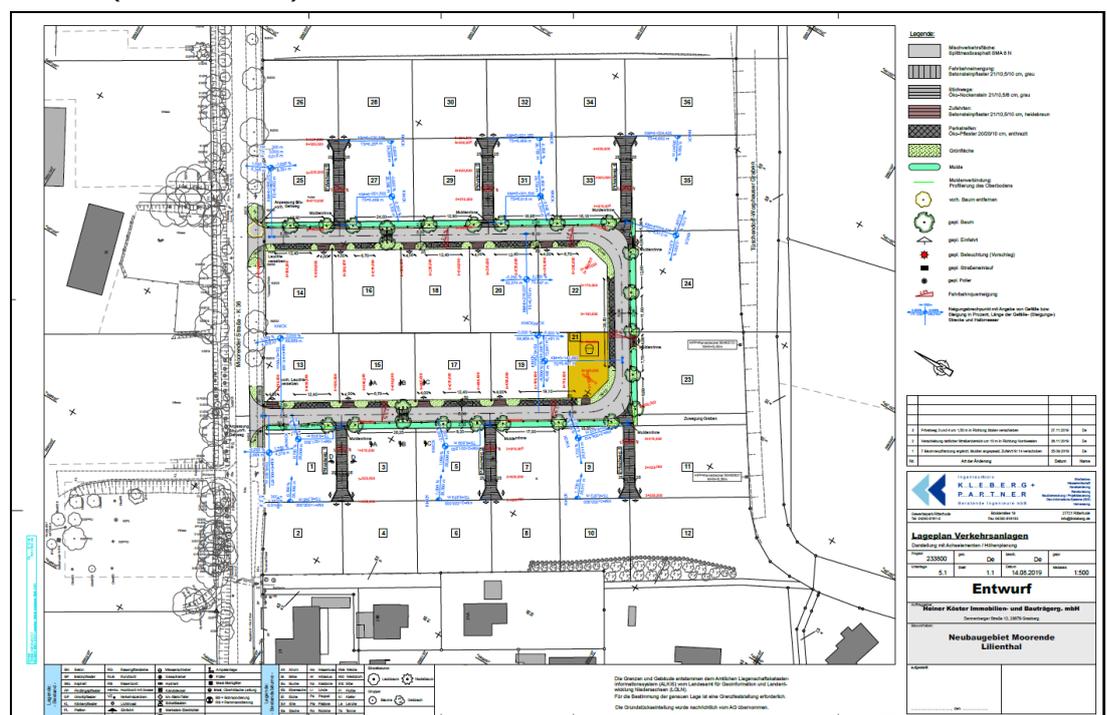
Lageplan Verkehrsanlagen (Stand: 14.08.2019), Quelle: Ingenieurbüro Kleberg+Partner, Ritterhude
